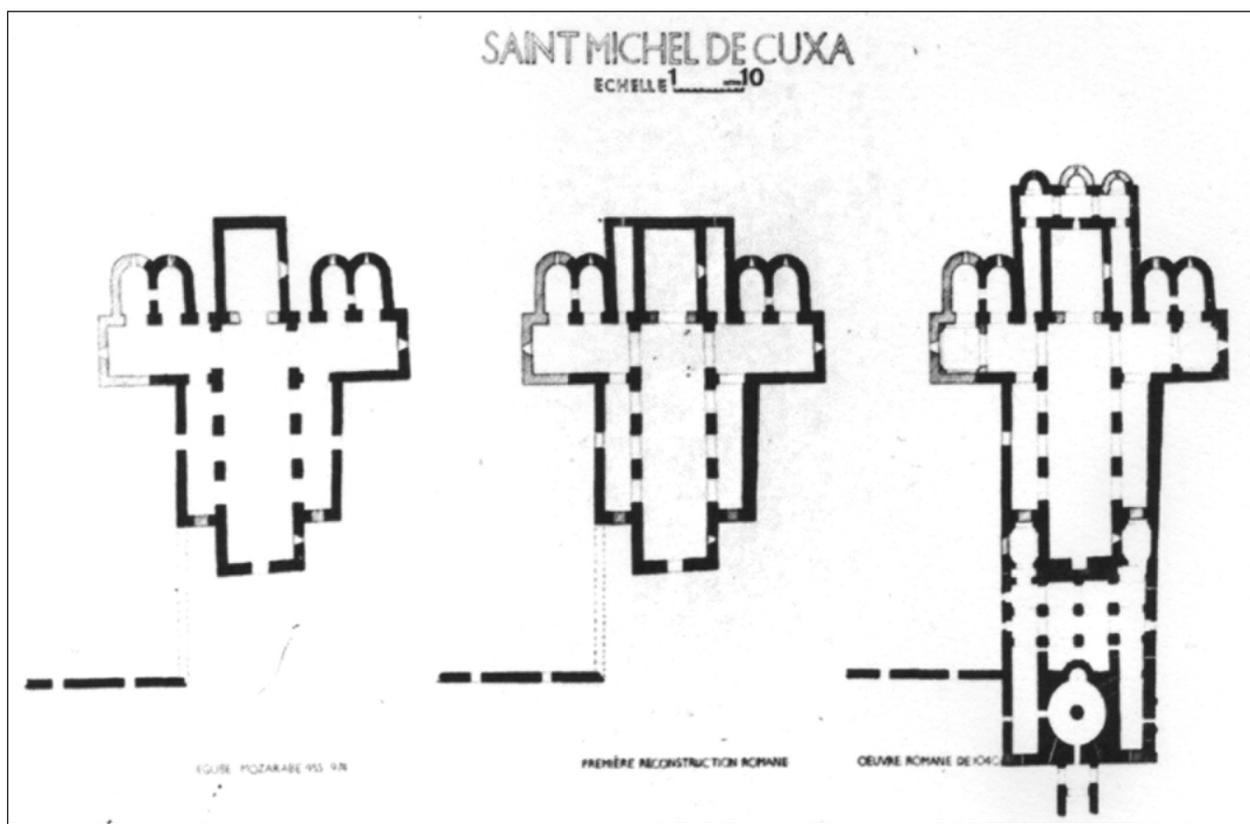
Plantas de Saint-Michel de Cuxa por fases constructivas, realizadas por Puig i Cadafalch en 1937 (Barral, 1977, 196). La primera fase es la planta de la iglesia del siglo X levantada por Garí, la segunda es la ampliación de los laterales del ábside y por último la ampliación de Oliba en el siglo XI según Puig i Cadafalch.
